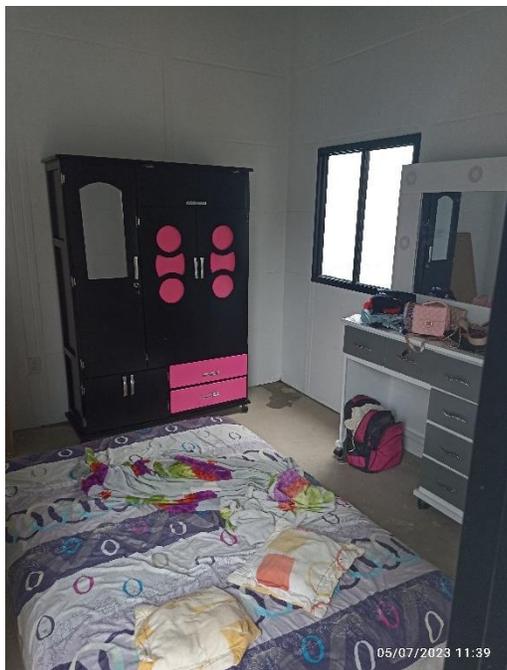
CASA 66 BARRIO BRISAS DEL LLANO. Ingreso de agua junta entre muros y losa / Fuente: Visita Técnica
